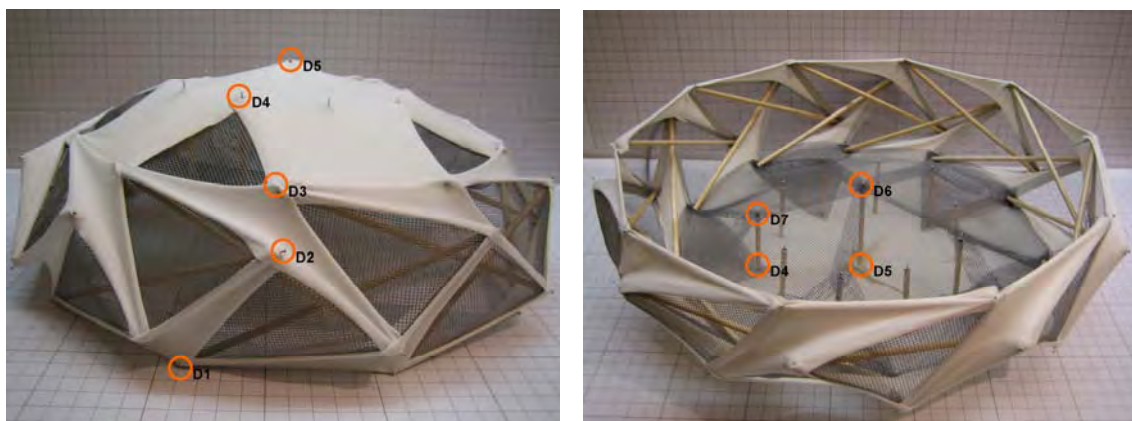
Detalles constructivos exteriores e internos del domo tensegrity.
